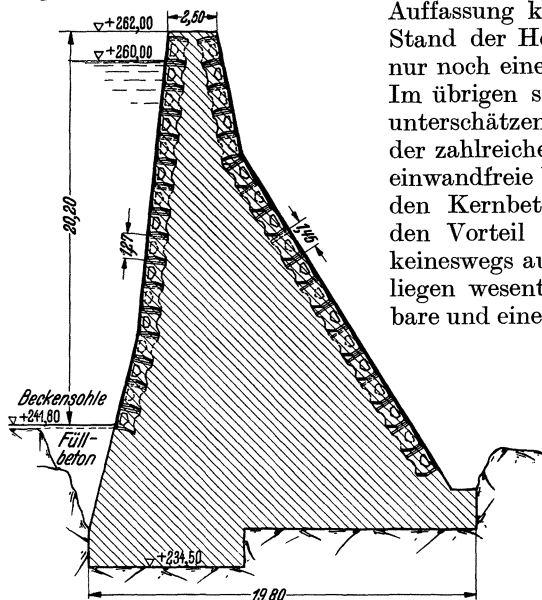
Querschnitt der Beckenmauer Hochspeicher Herdecke mit Betonformsteinen.
